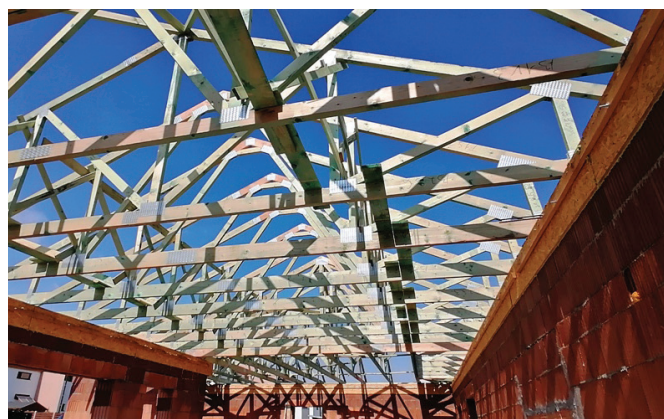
Šikmá střecha – dodržení technologických postupů a konstrukčních detailů střechy.
